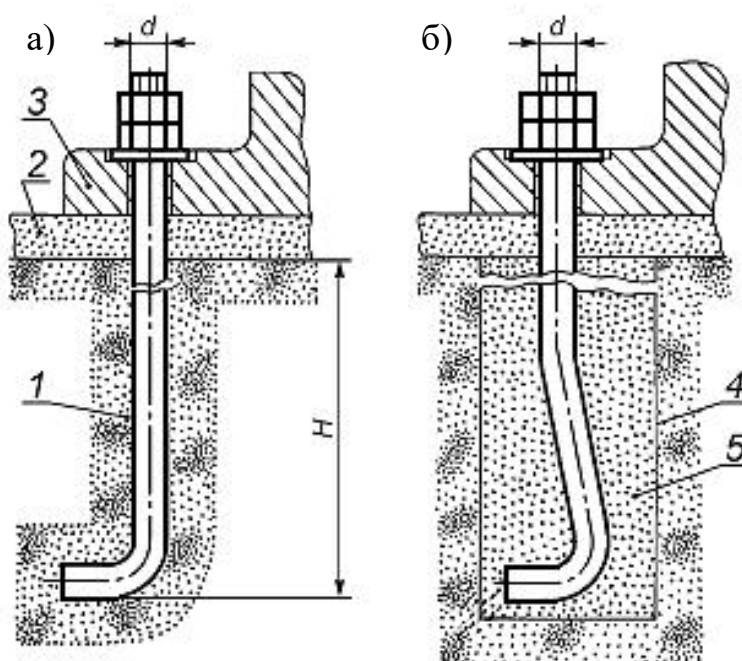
Эскиз фундаментного болта ГОСТ 24379.1-2012: 1 – фундамент; 2 – подливка; 3 – оборудование или строительная конструкция; 4 – колодец; 5 – бетон на мелком заполнителе
